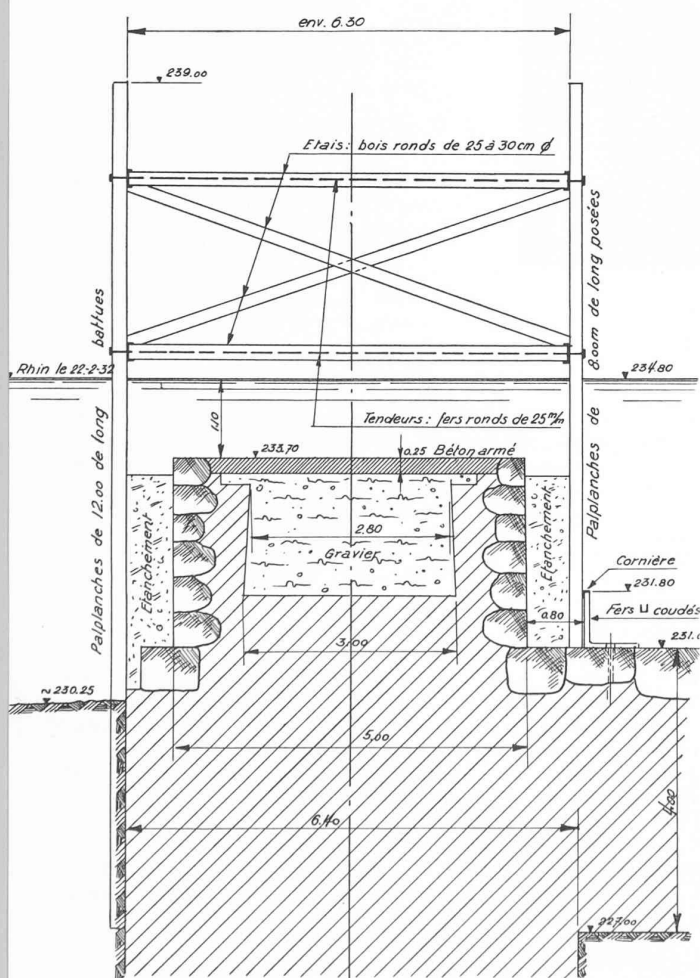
Pile III. 2^e étape de travaux. — Coupe transversale de la pile. — Echelle 1 : 100.
